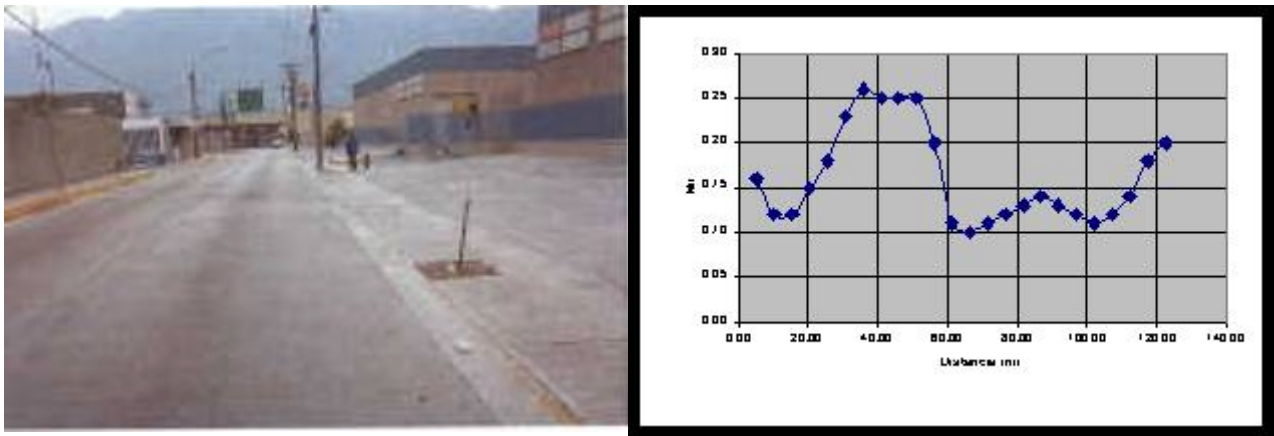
Pavimento de Concreto Hidráulico, Calle 20 de Noviembre .
